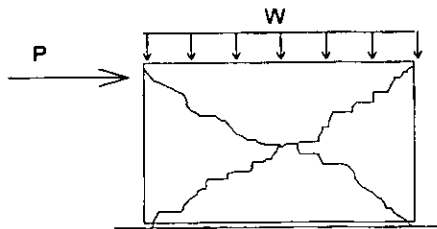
Grietas en el muro originadas por la falla a cortante.
